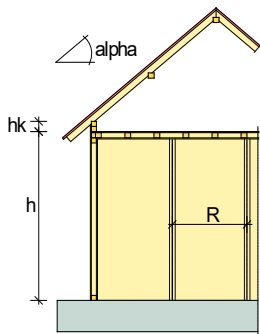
Definition zur Dachgeometrie und der Geschosshöhe
